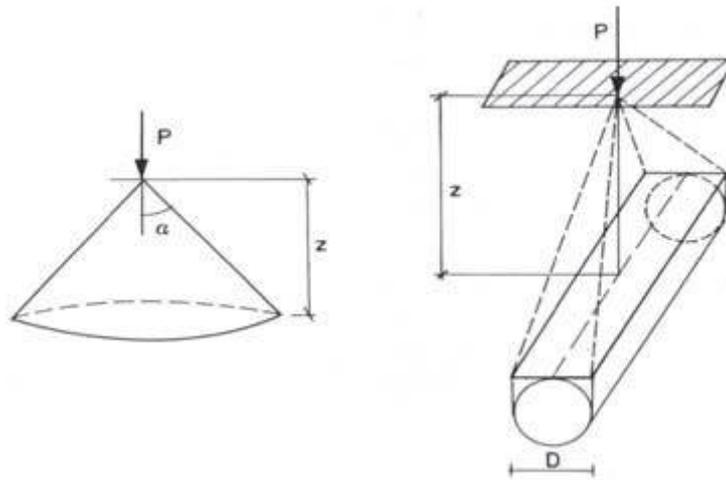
Distribuzione delle pressioni lungo la verticale dovute a un carico concentrato e superficie di tubazione interessata dalle stessa
